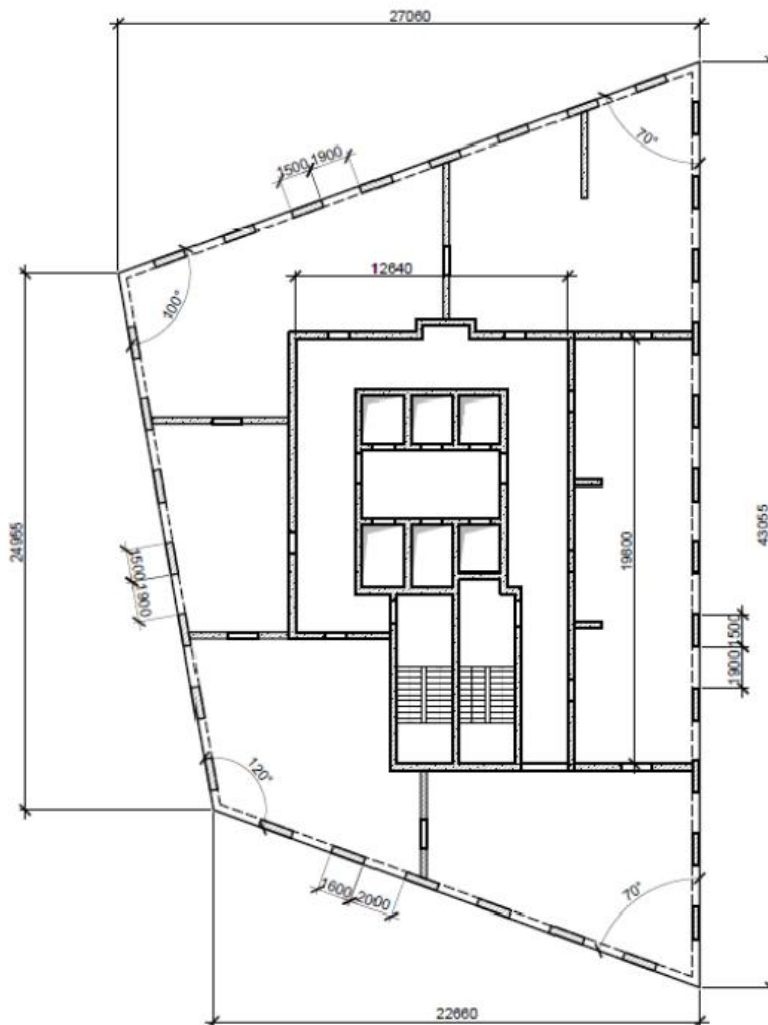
Конструкция типового этажа высотного здания из монолитного железобетона.
